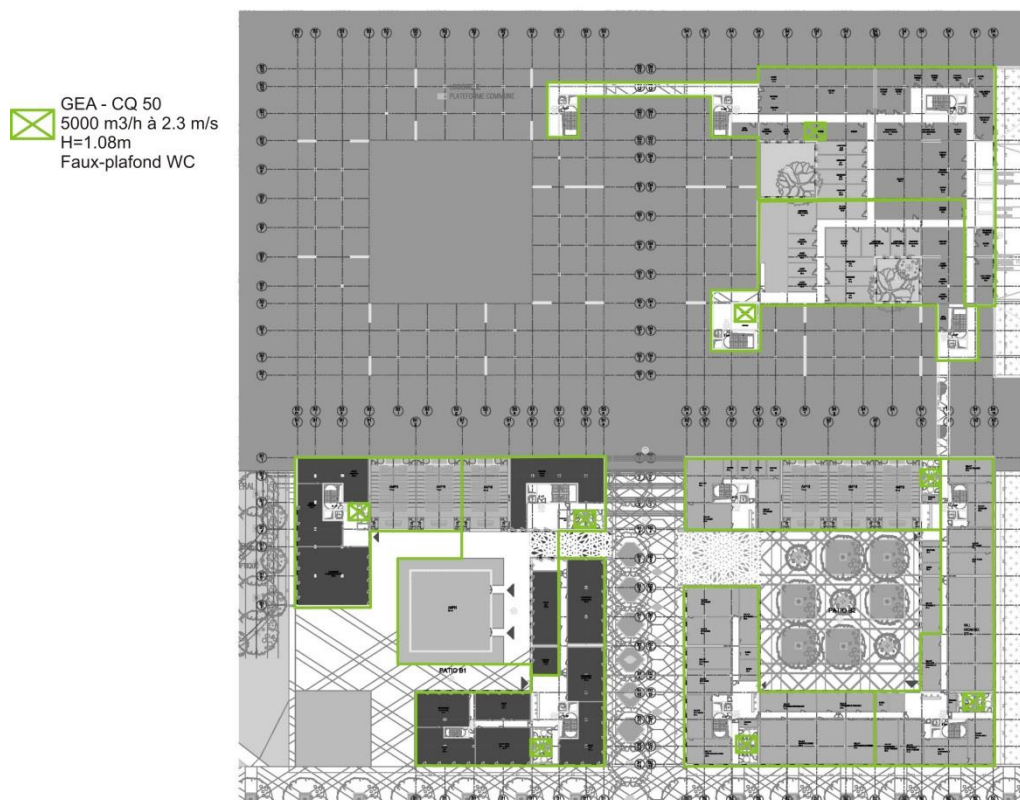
Plan d'implantation des CTA – B1B2 RDC – B3B4 SS
